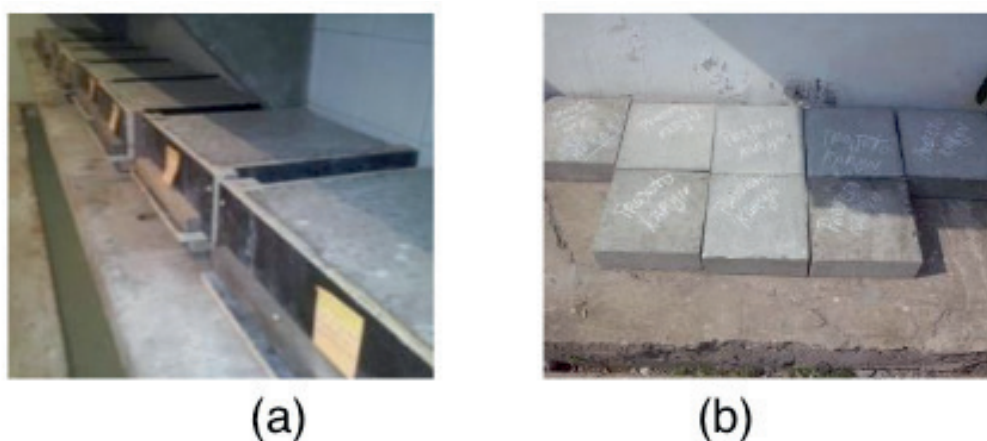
Placas de concreto - (a) com as fôrmas de madeira - (b) as placas prontas
